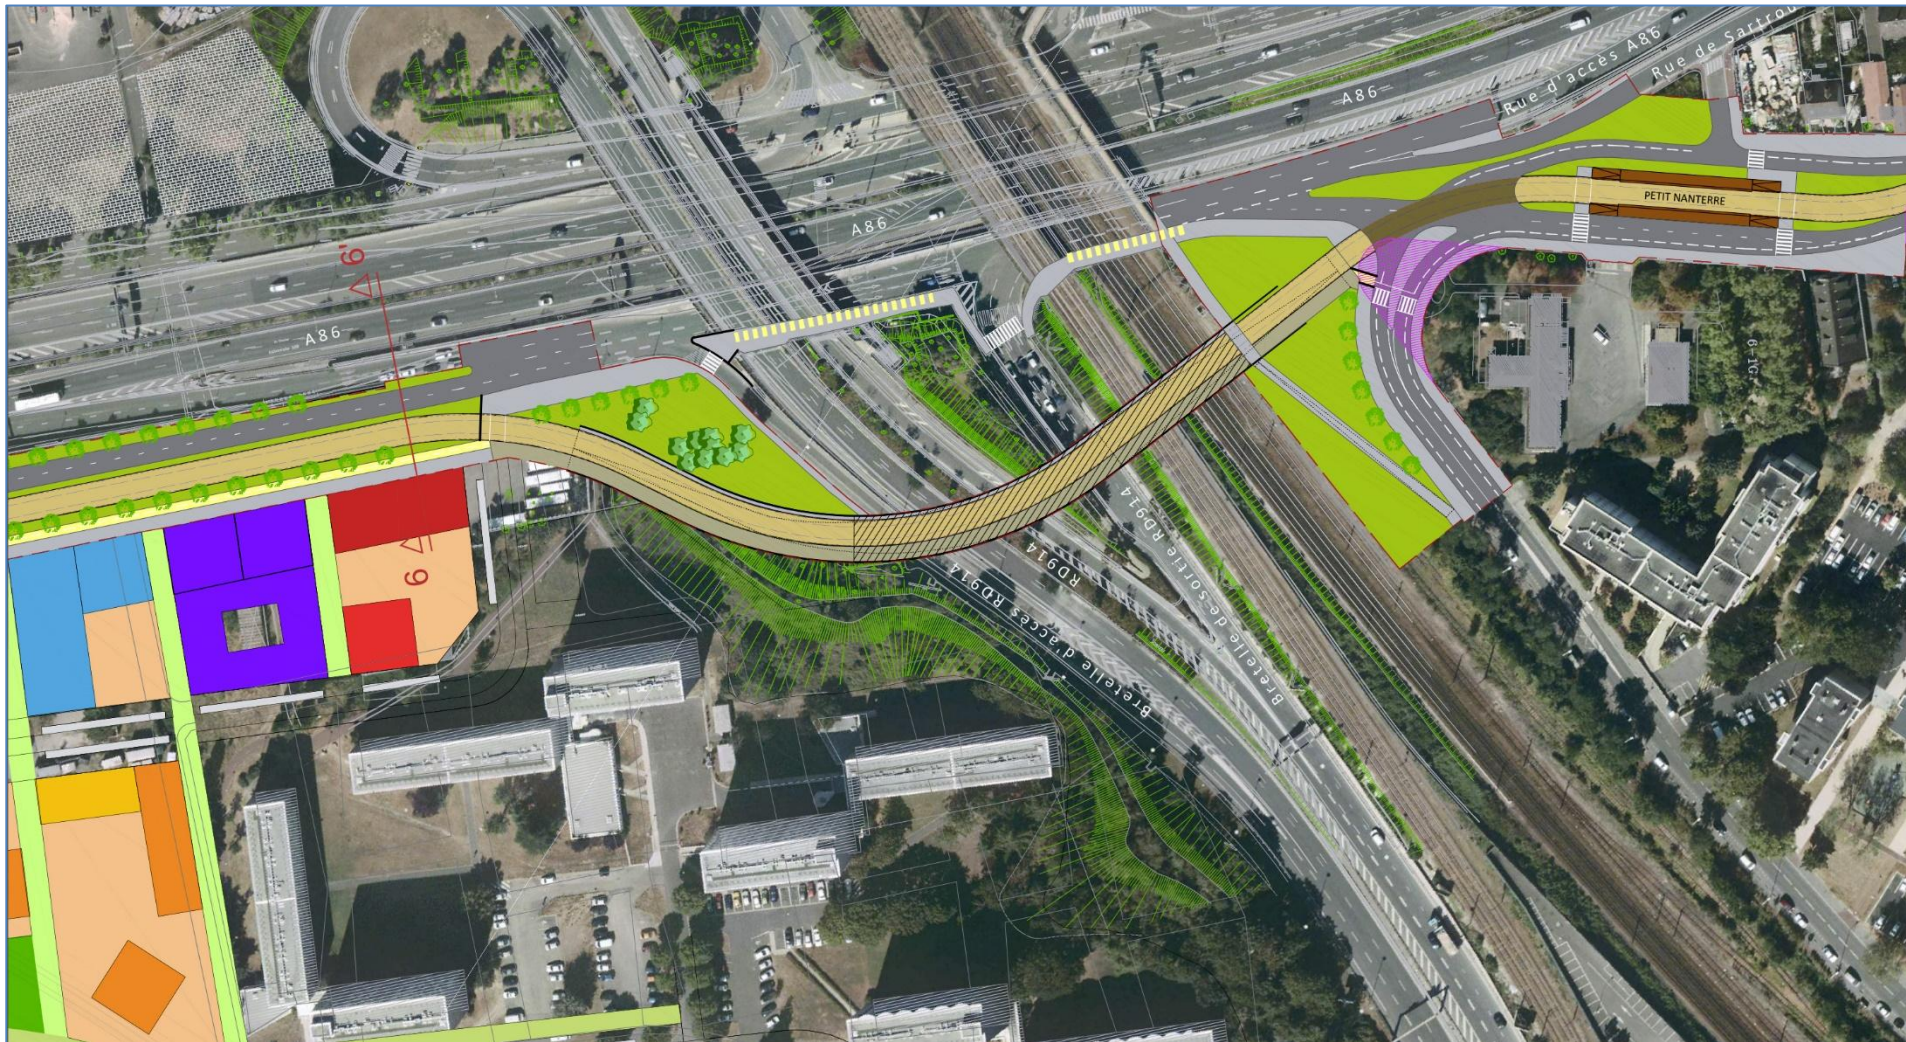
Séquence 1 – section D – Franchissement sans croisement
